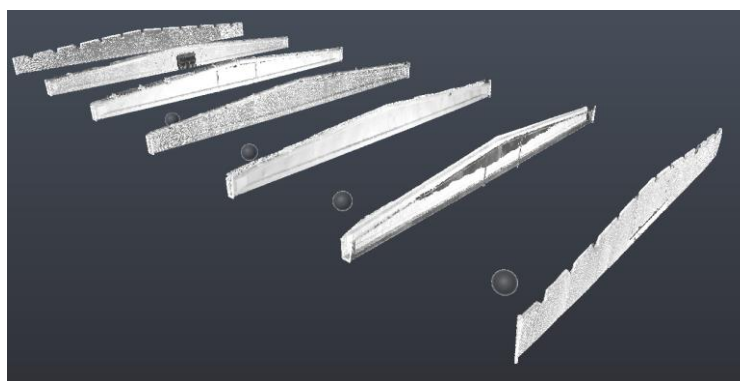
Стропильные балки спортивного корпуса КнАГУ
